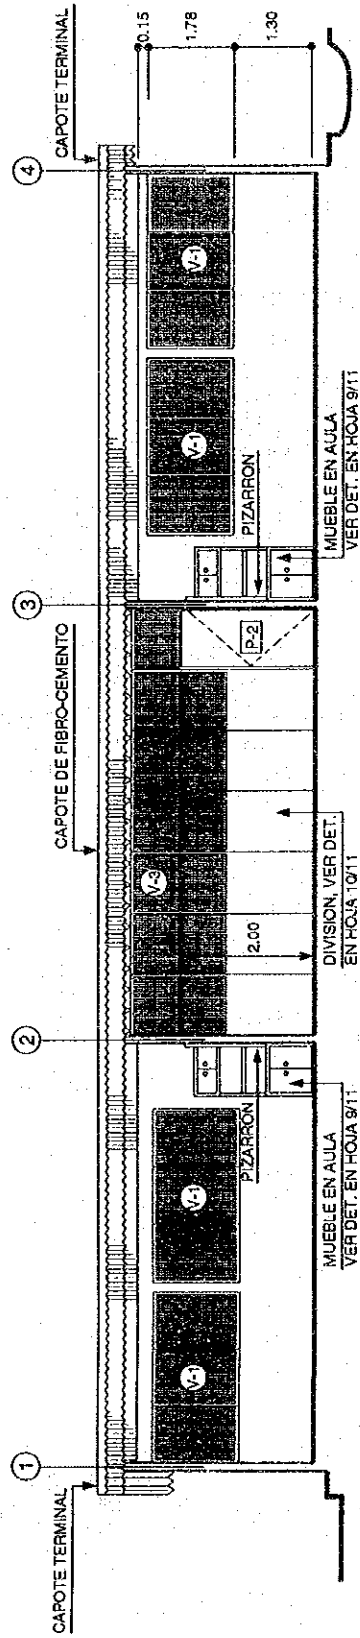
初等教育学校施設平面図 (3-3-6タイプ)
